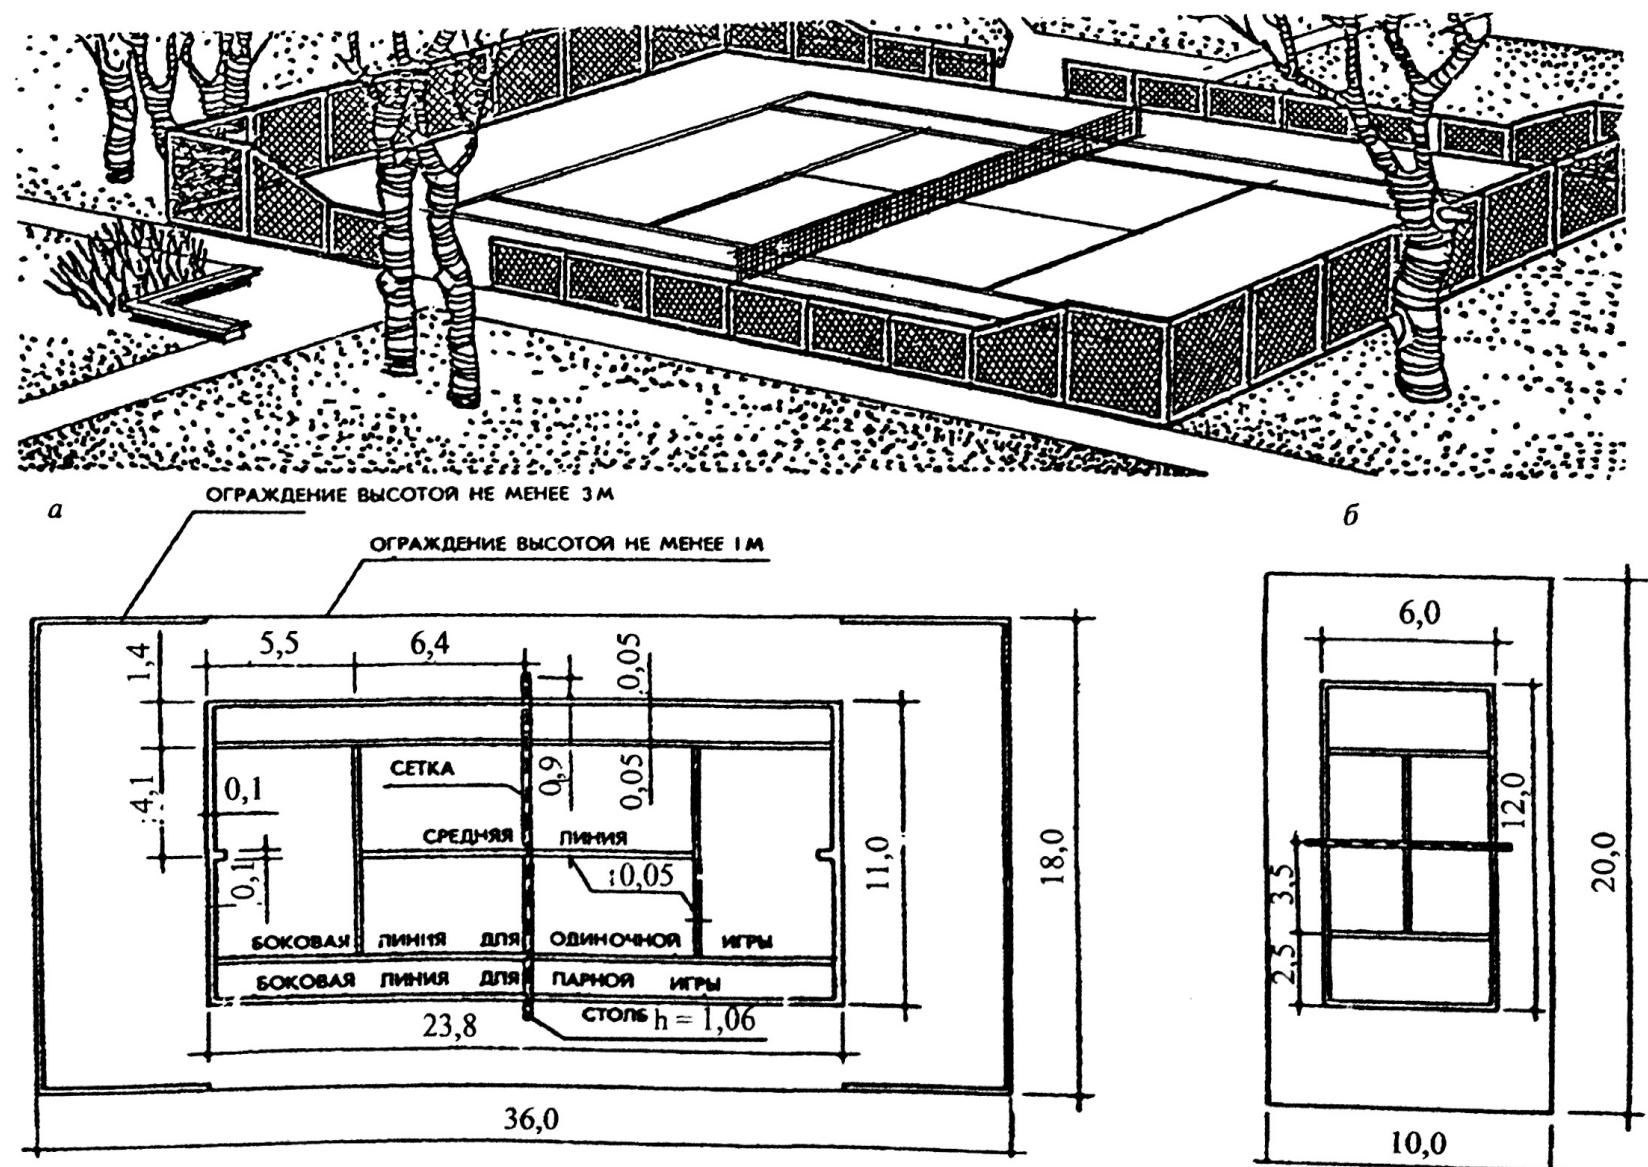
Планы и размеры разметки площадок для игры в теннис: а – площадки нормальных размеров; б – площадка для игры в малый теннис
